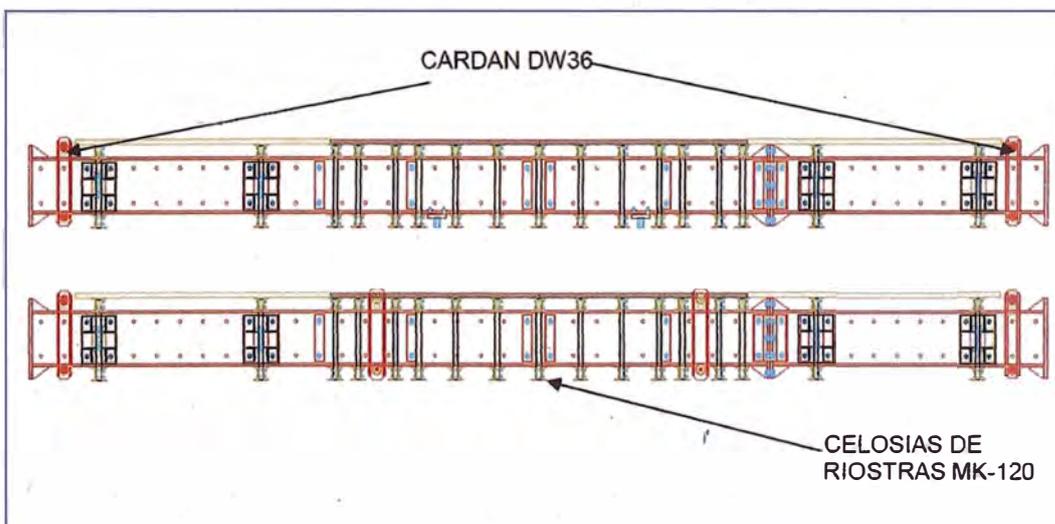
Vista vigas transversales U-500 - Fuente: Elaboración Propia
